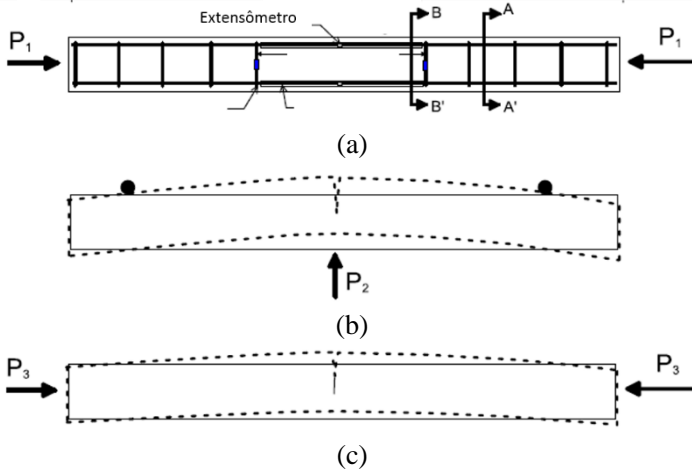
Carregamentos divididos em (a) fase 1, (b) fase 2 e (c) fase 3.
